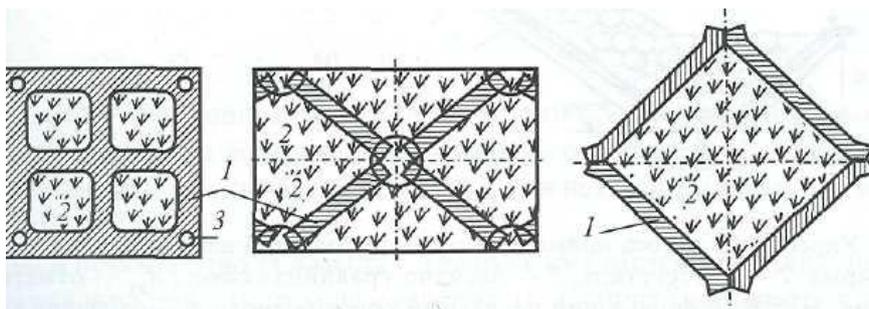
Железобетонные обрешетки для укрепления откосов:
